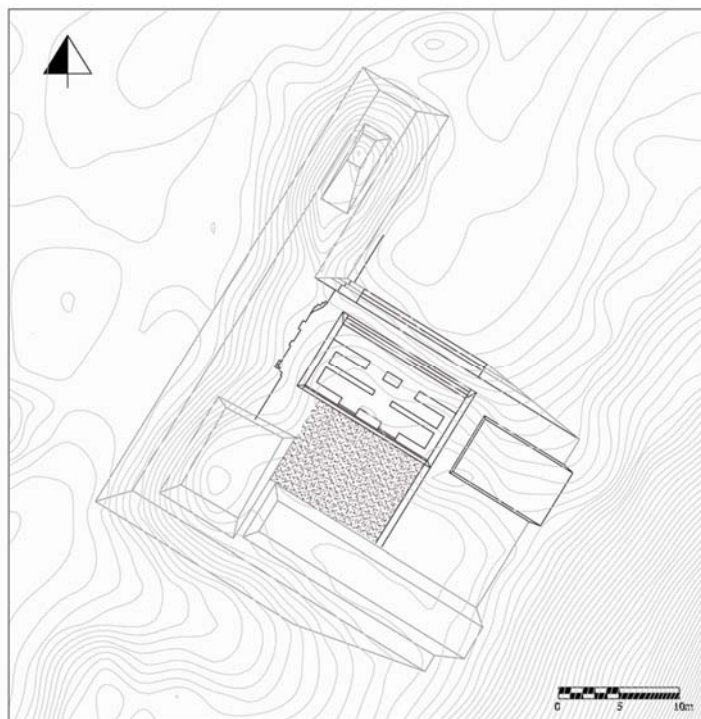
Dibujo reconstructivo en planta de la estr. D-4a del conjunto CHK/D87 insertada en su contexto (PRACH- elaboración A. Campiani)
